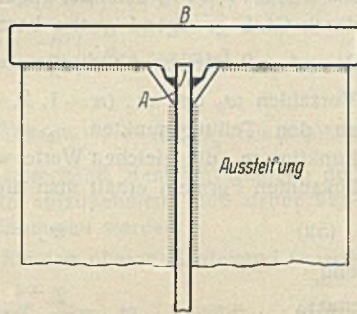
Flanschprofil zur Bildung von Blechträgern.
